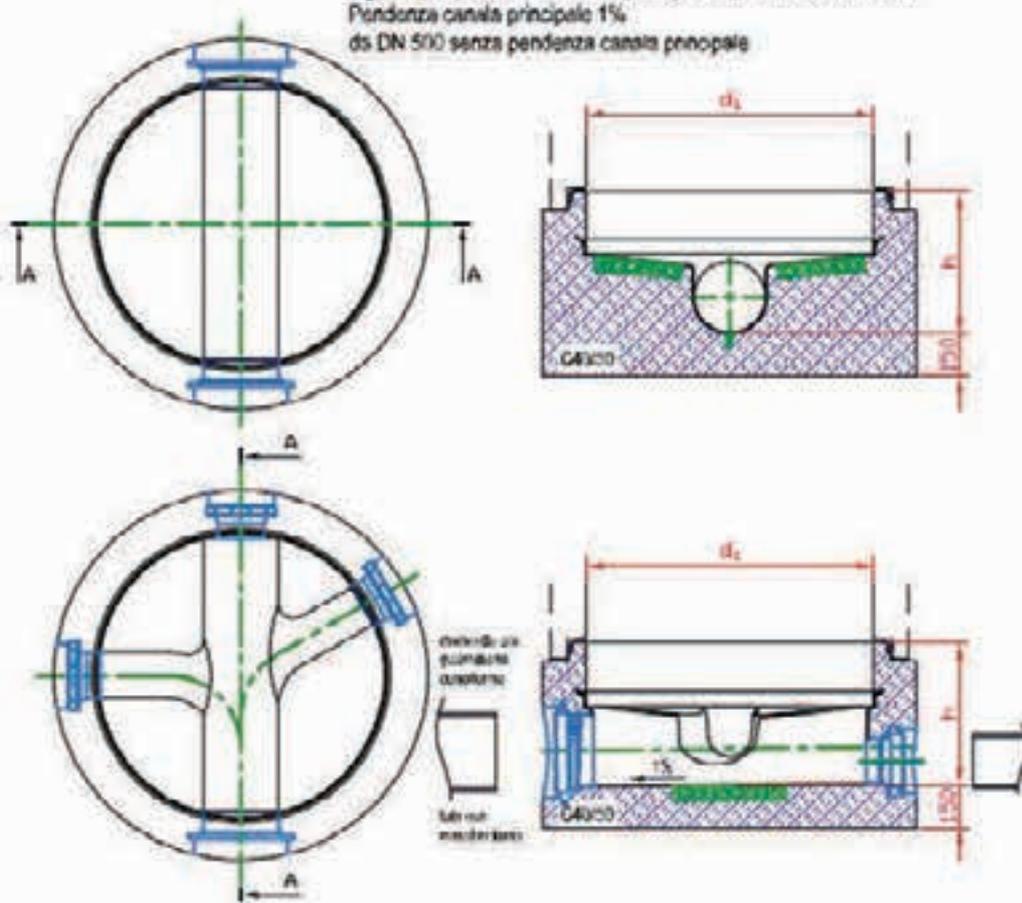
Particolare struttura pozzetto di ispezione a norma DIN V 4034 / EN 1917 con fondo in PP incorporato
